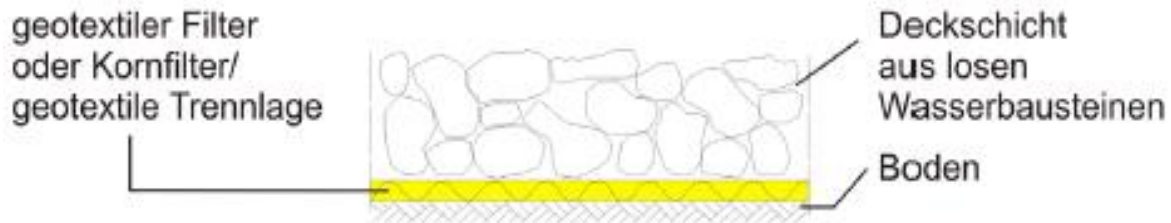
Deckwerke mit einer Deckschicht aus losen Wasserbausteine [56]
